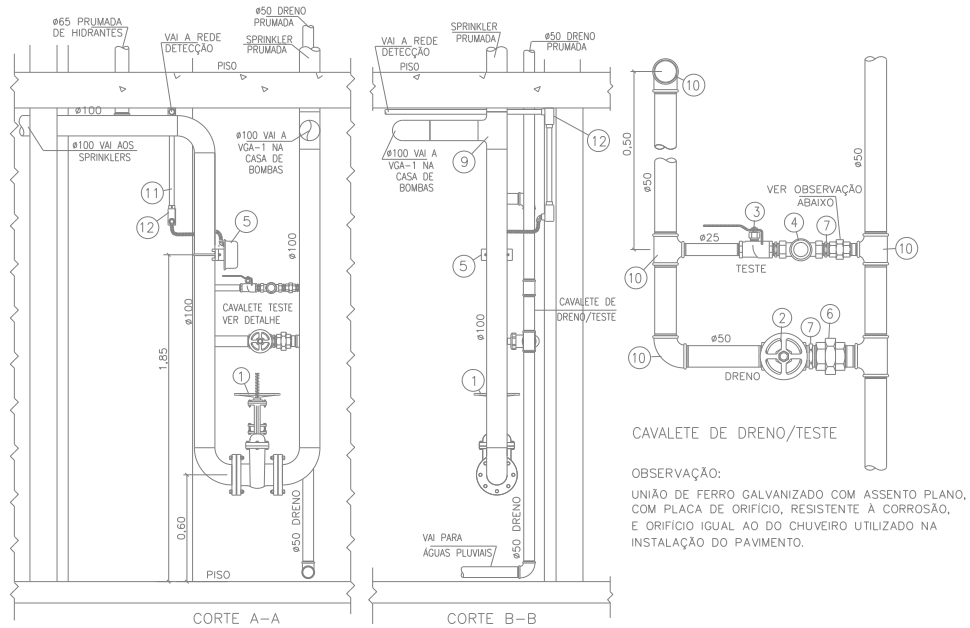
Exemplos conexão de ensaio e cavalete de dreno. Fonte: O autor.
